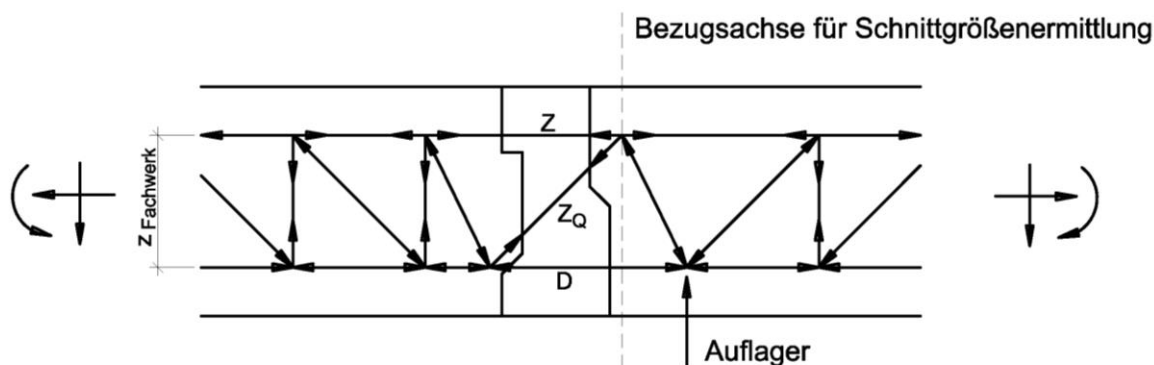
Schöck Isokorb Typ RK-239 und Typ RKX-239
